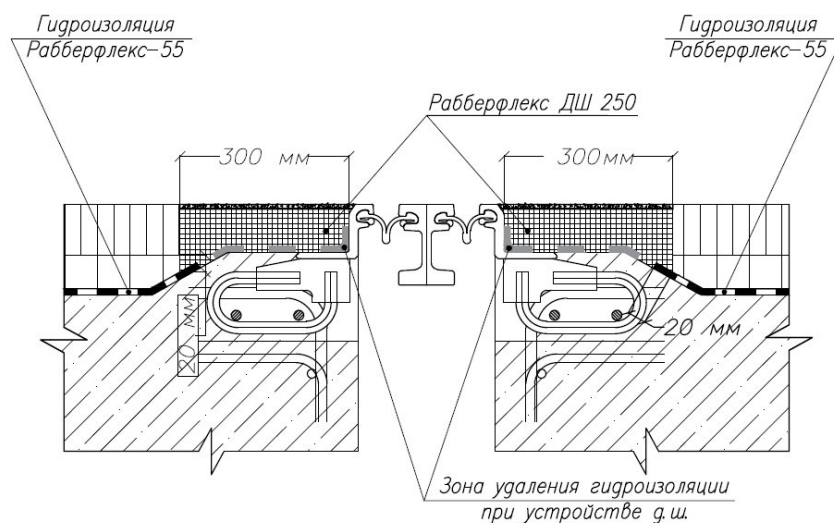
Схематическое изображение зоны сопряжения асфальтобетонного покрытия с деформационным швом с металлическим окаймлением на железобетонном пролётном строение
